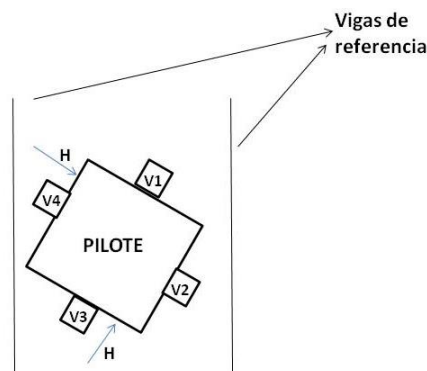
Vista en planta de la distribución de sensores LVDT
